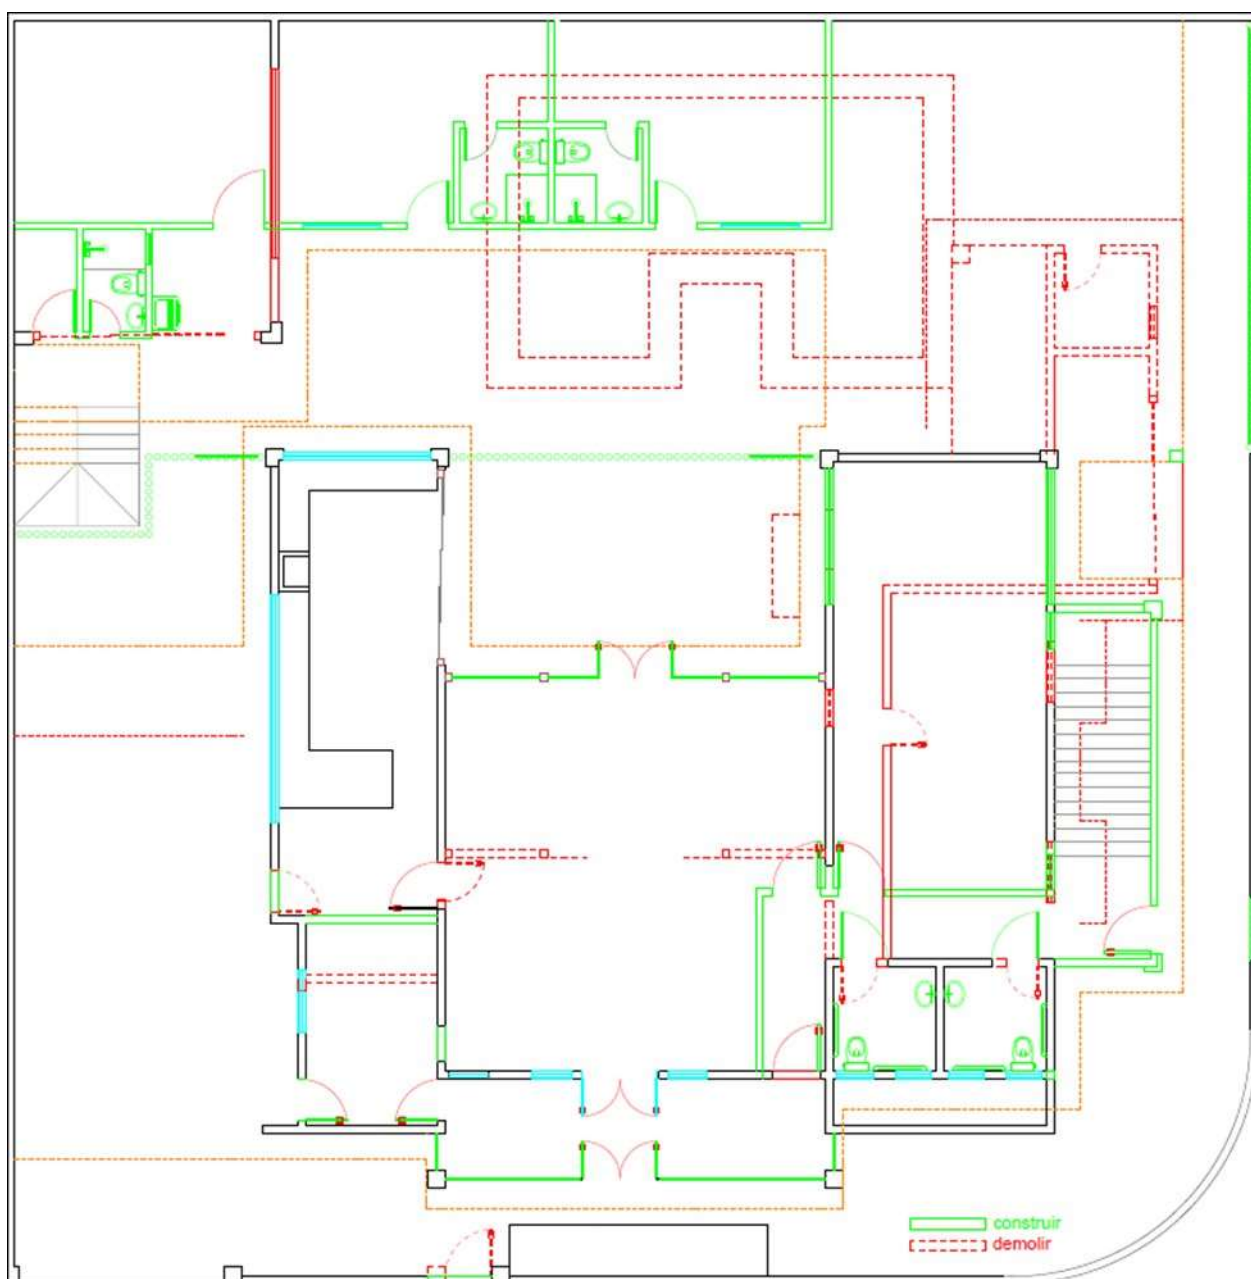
proposta de planta-baixa e alterações para o pavimento térreo.
